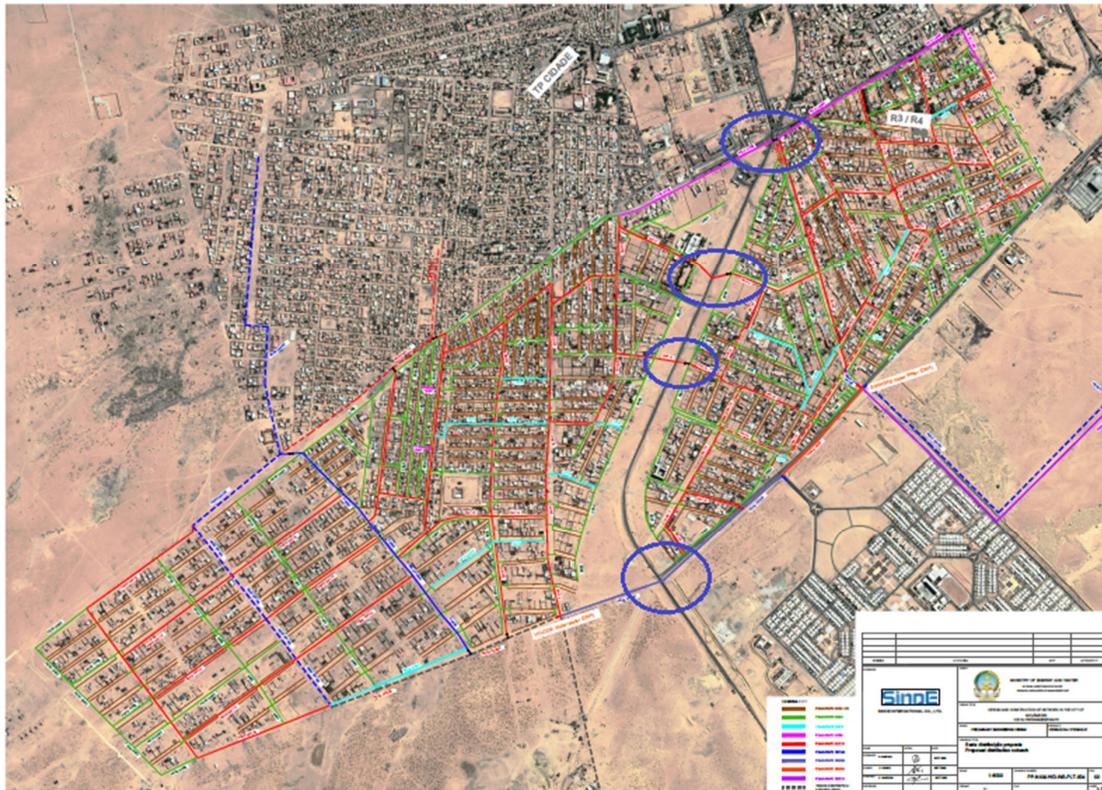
Planta de implantação geral do projeto c/ cruzamentos entre condutas e EN100 (marcados a azul)
